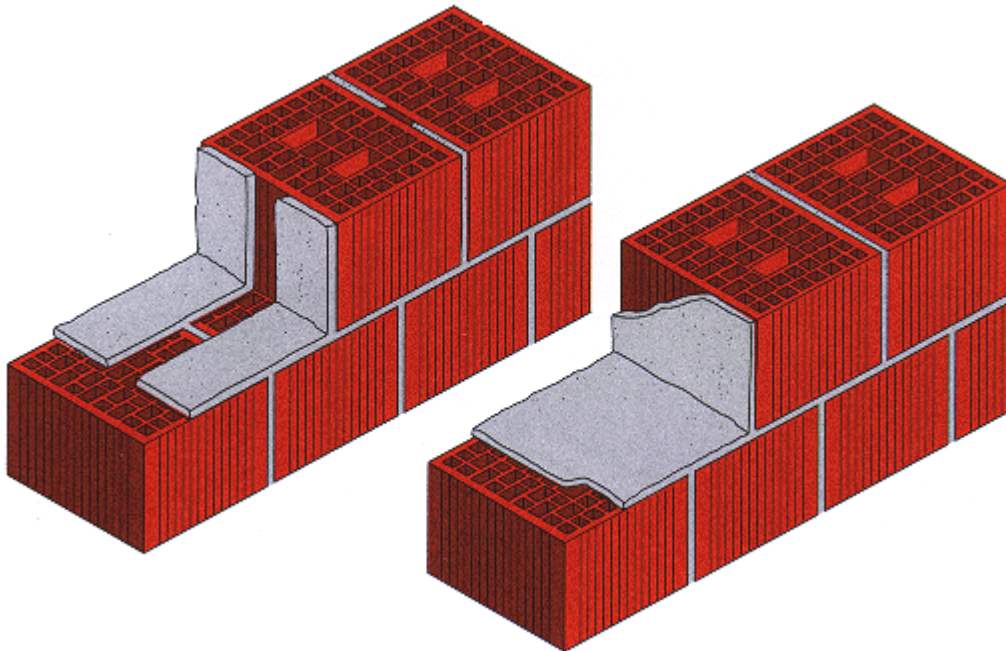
Muratura con giunto interrotto e giunto continuo.
